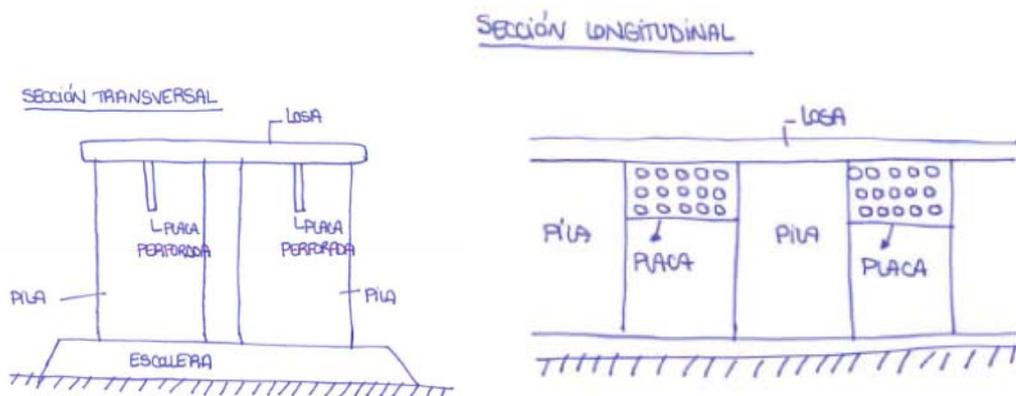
Secciones longitudinal y transversal del espigón
